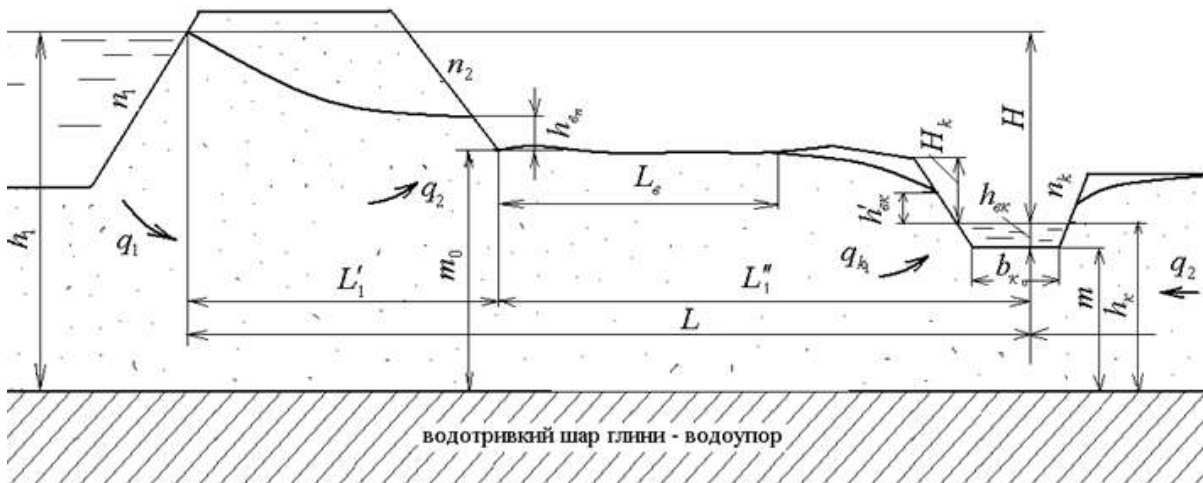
Розрахункова схема дамби (греблі) з дренажним каналом (руслom) (схеми 2,3)
